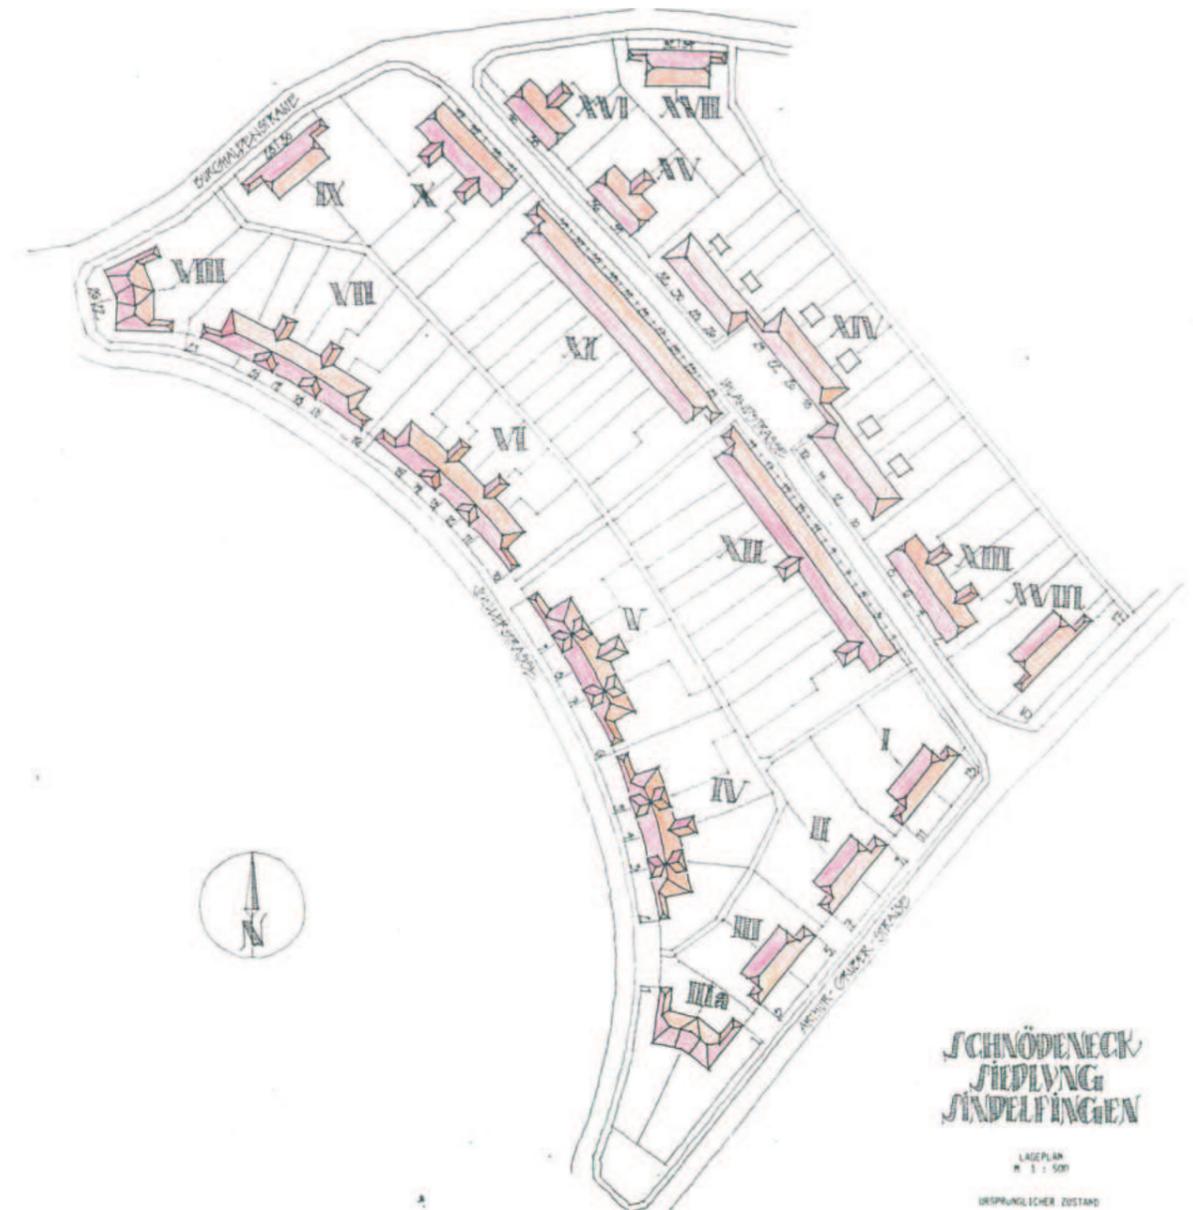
Lageplan der Siedlung mit Bezeichnung der Hausgruppen, Untersuchung Prof. Bosse, 1984
